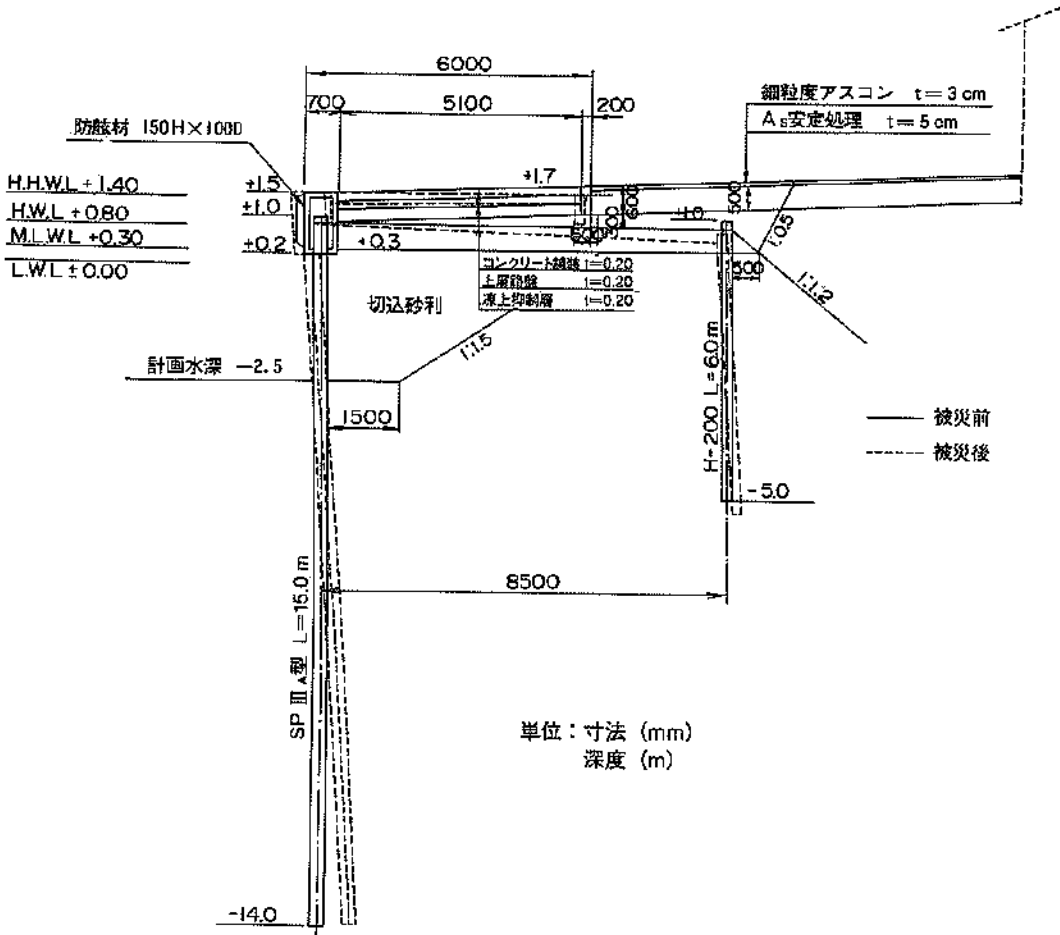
標準断面図 (上磯漁港、④-2.5m 物揚場)
